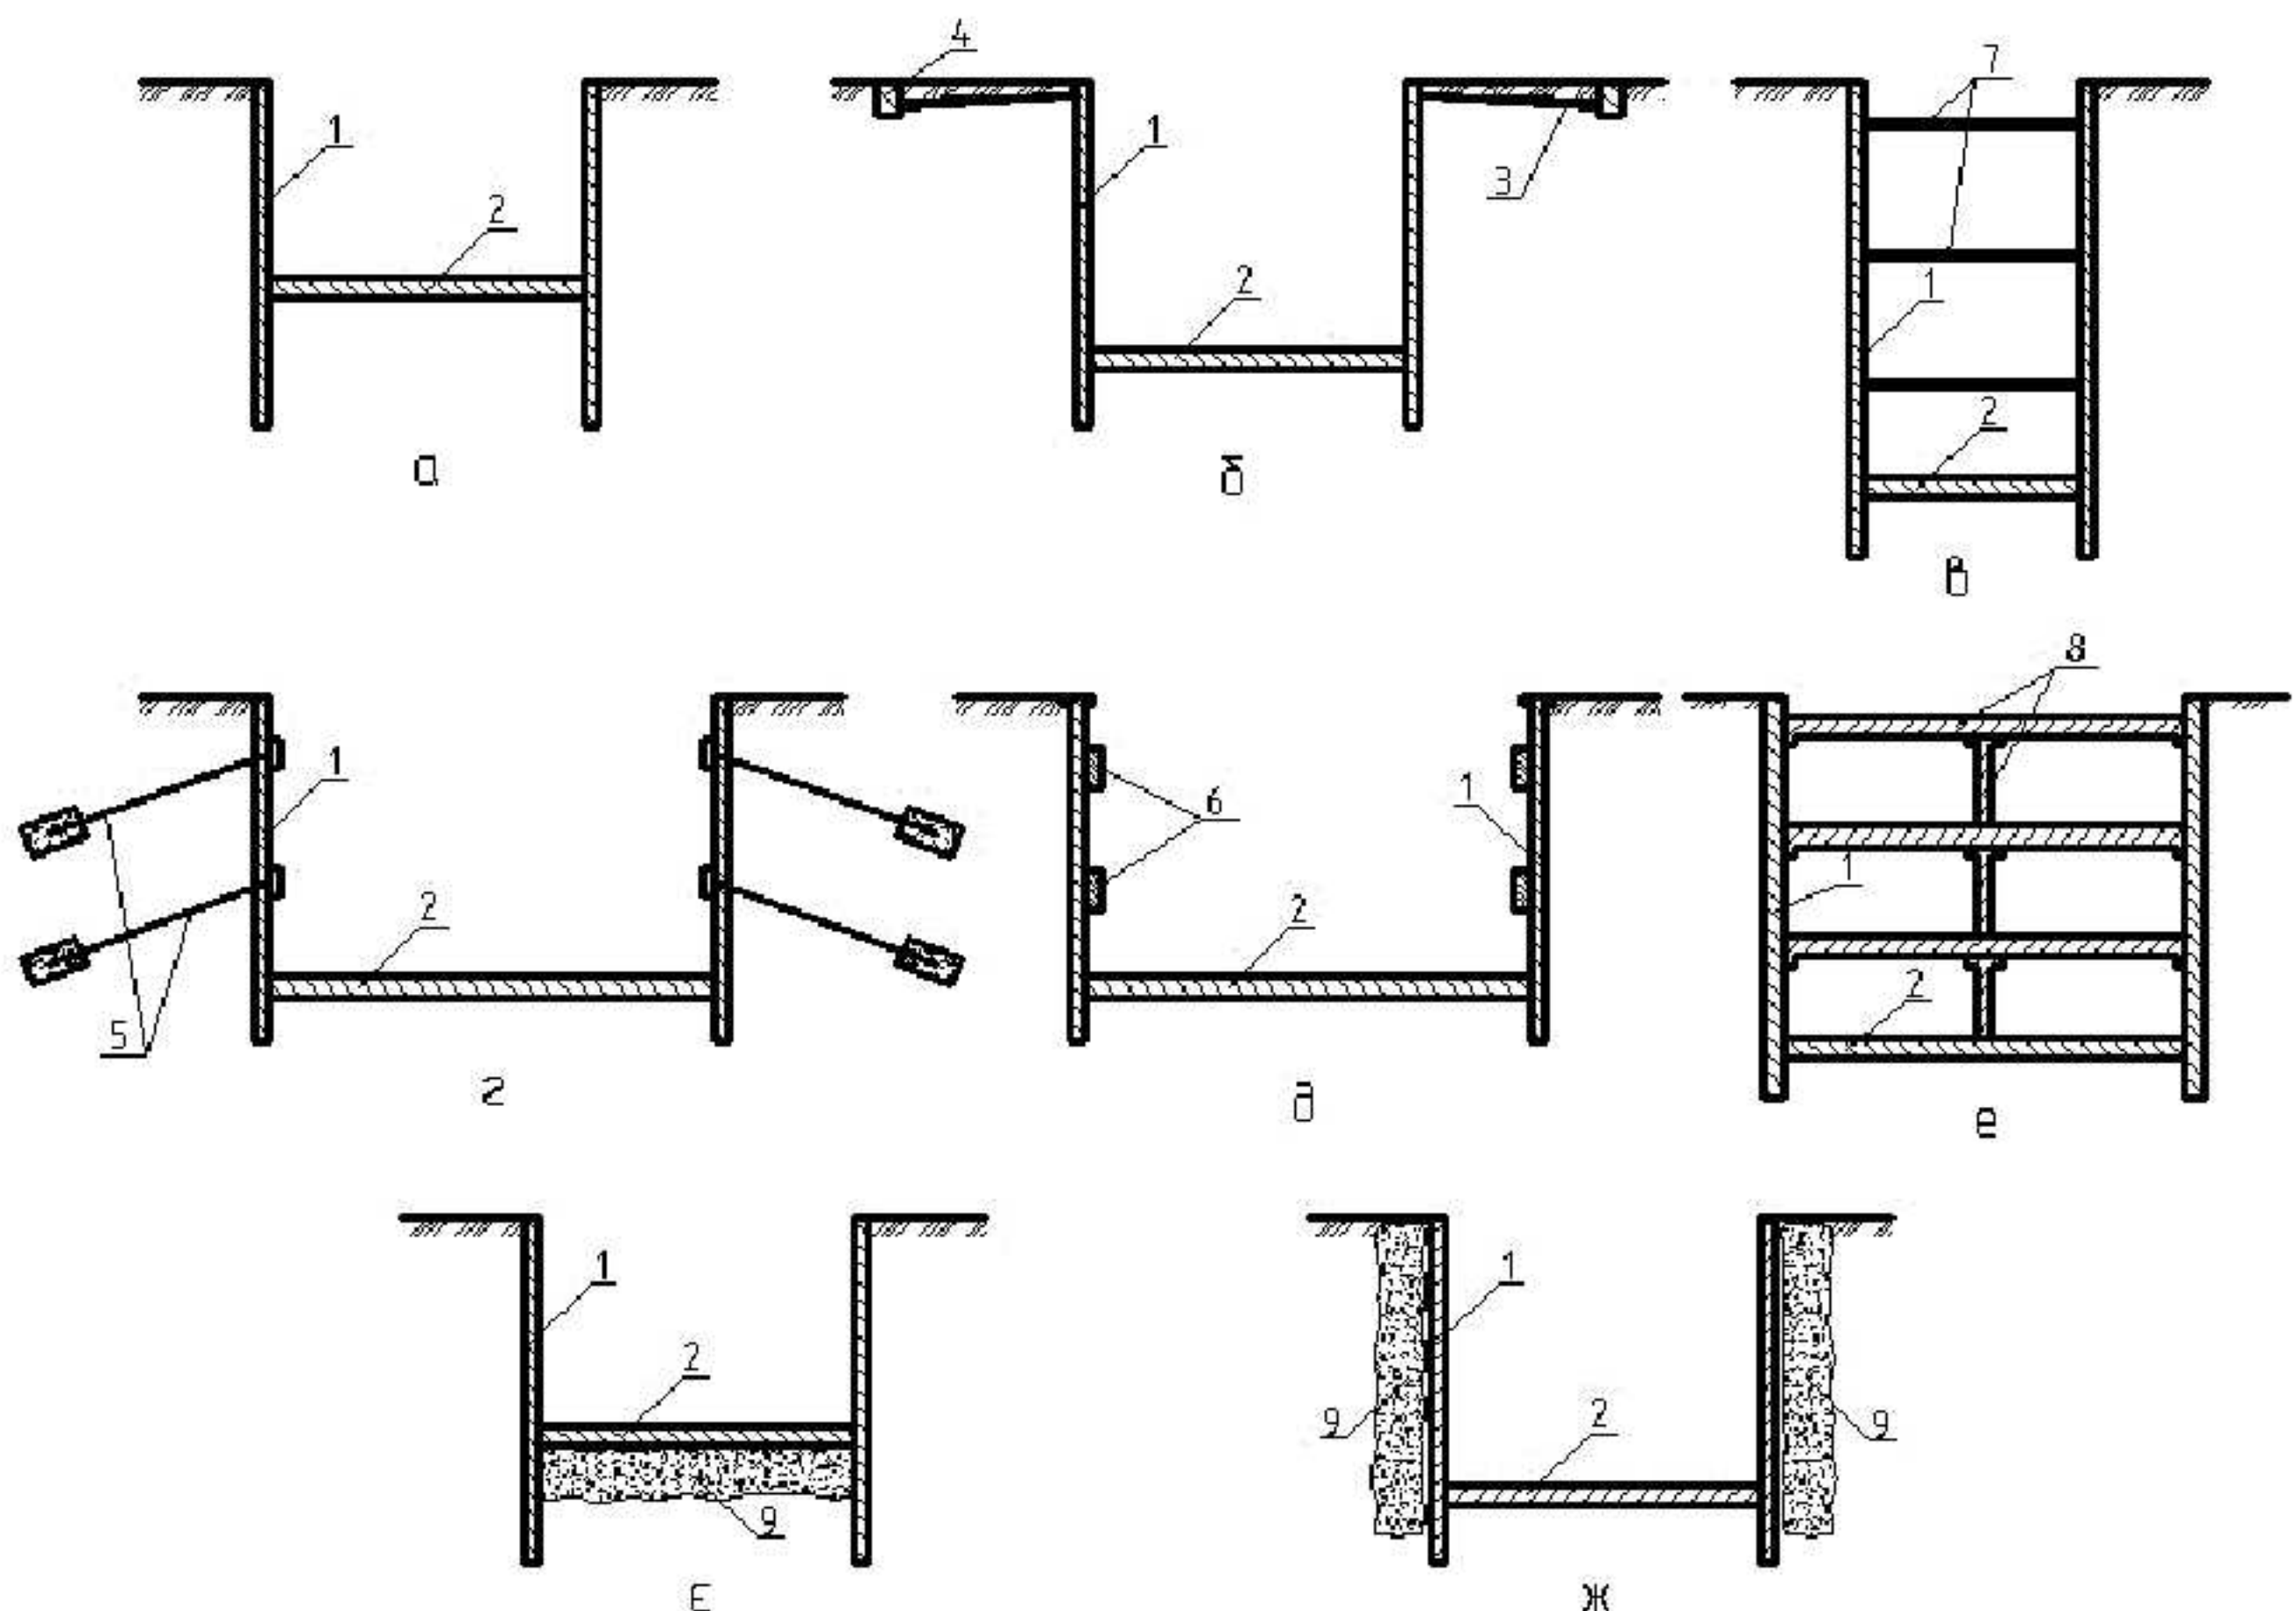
Схеми забезпечення стійкості стін котловану в період розробки ґрунту
